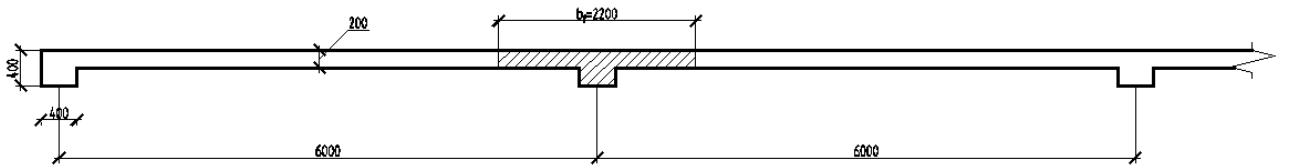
Расчетное сопротивление главной балки при расчете на положительный изгибающий момент
